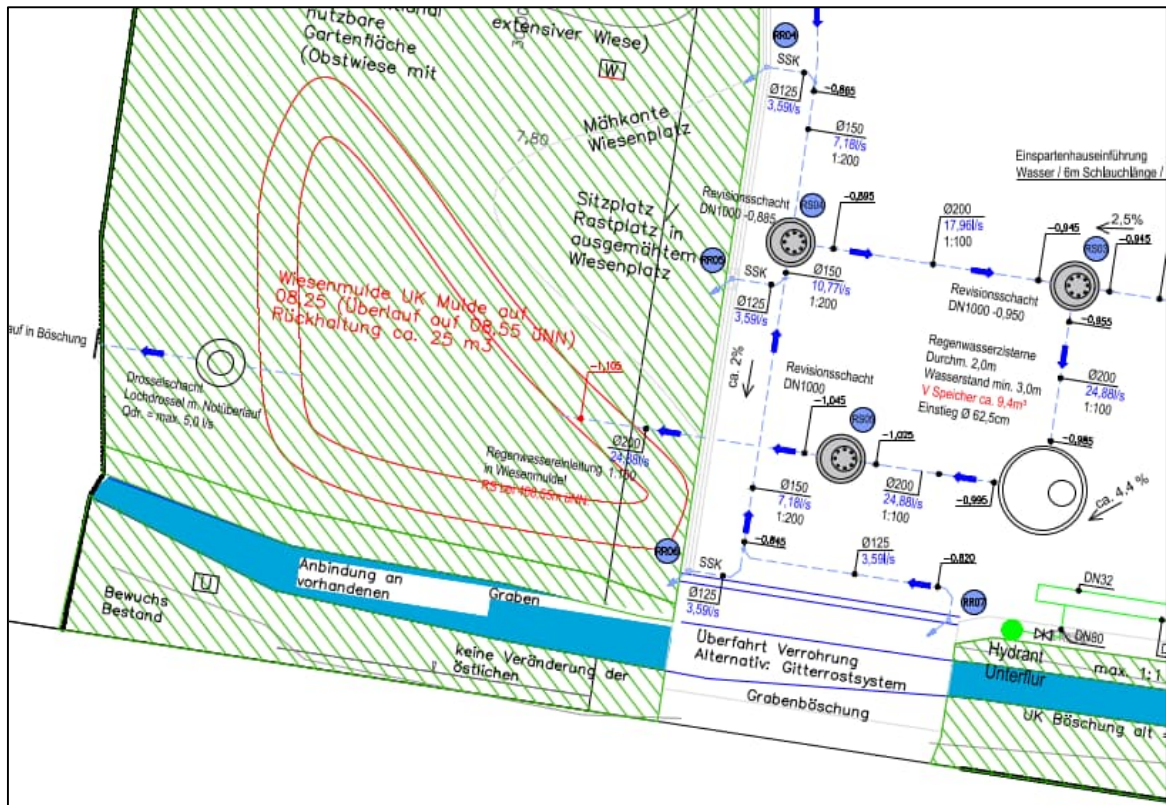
Ausschnitt Entwässerungseingabepfan, 23.12.2024, Planungsbüro Schmid
